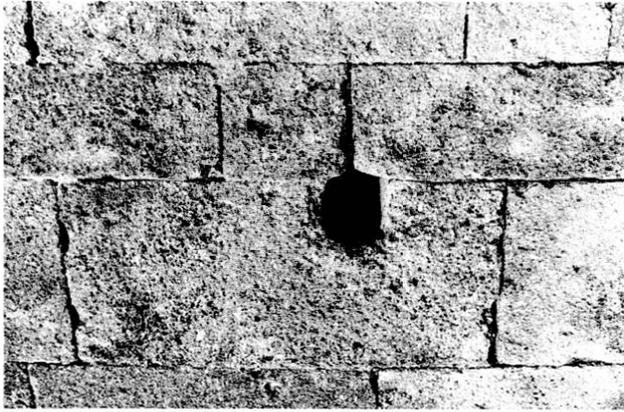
Détail d'un trou de boulin sur la façade sud.
